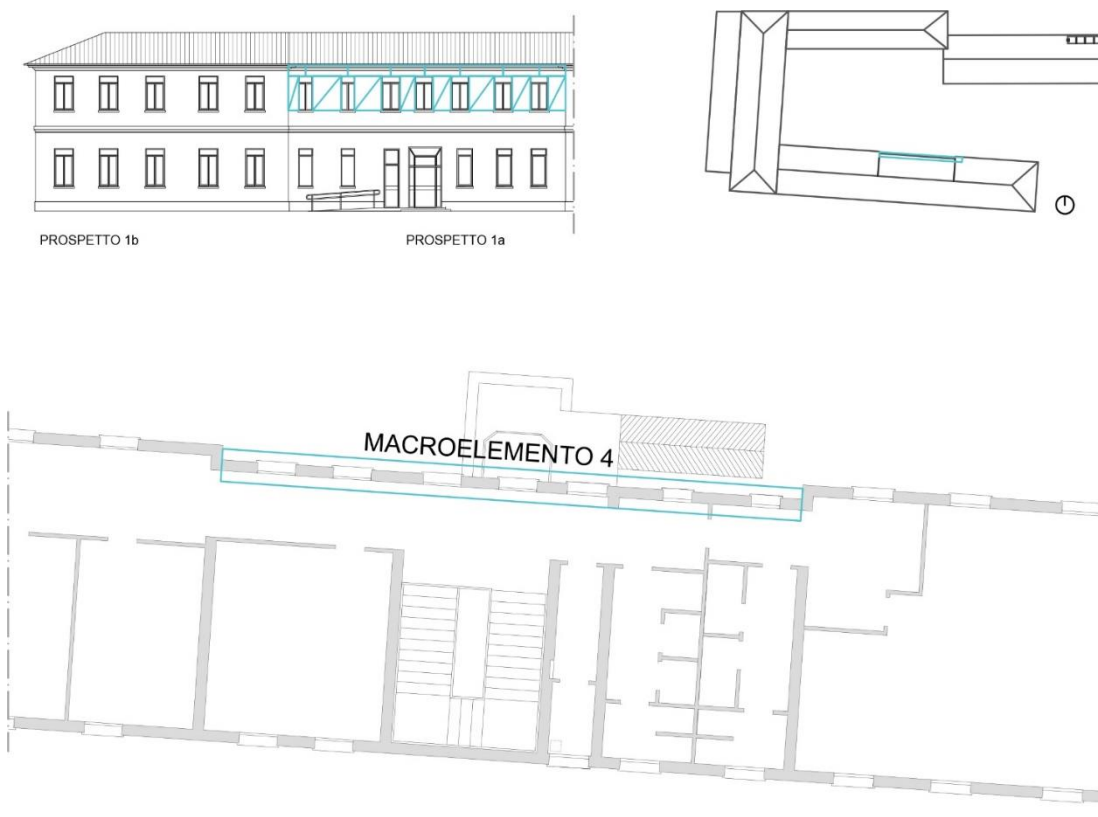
Individuazione del macroelemento in prospetto e pianta
